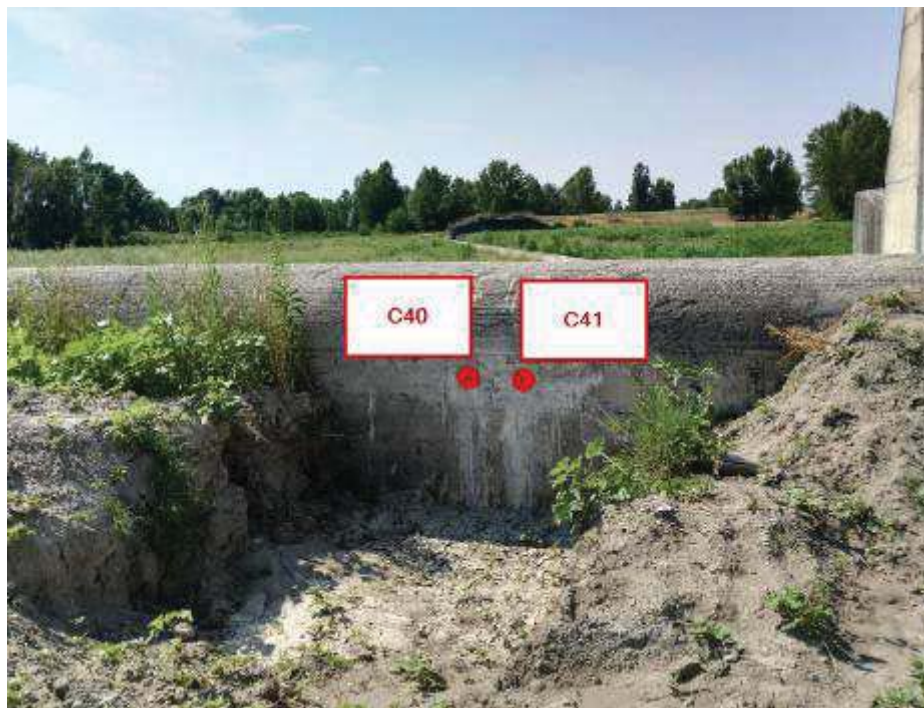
Manufatto limitatore di Monte. Esecuzione prelievi carote in fondazione
